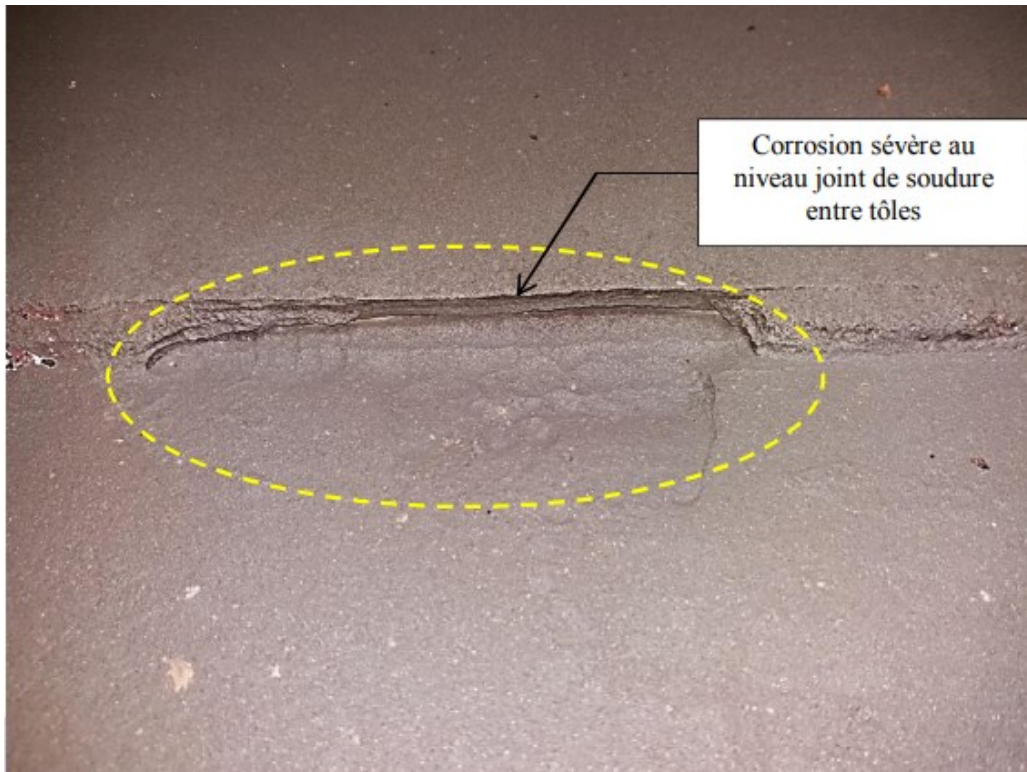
Corrosion sévère au niveau de joint de soudure entre tôles
